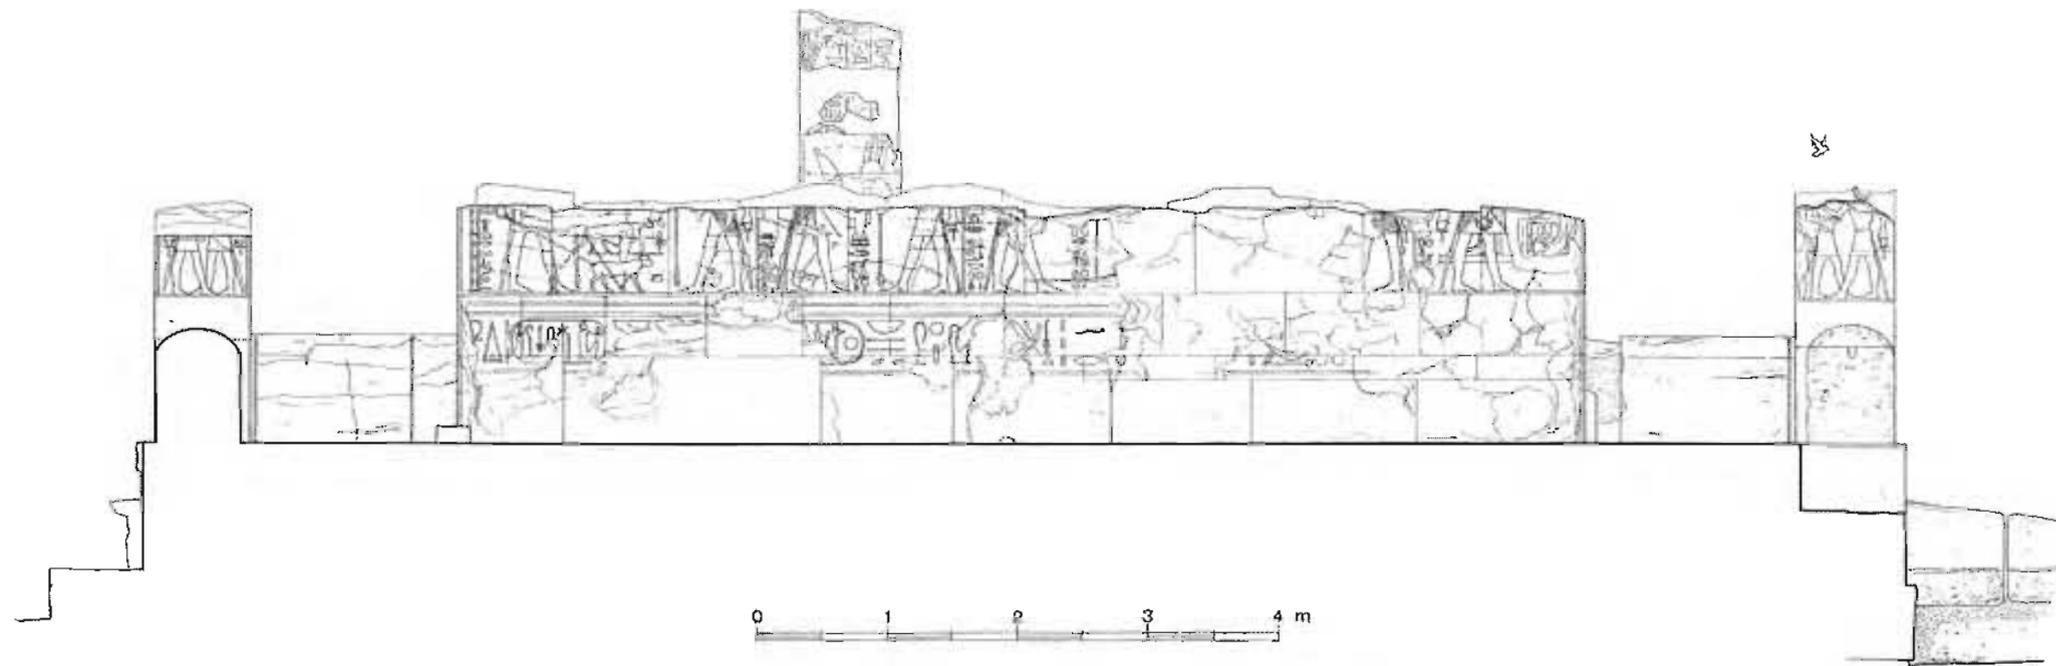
Coupe Coupe sur la galerie ouest vers l'est (mur est du sanctuaire), OO'.
